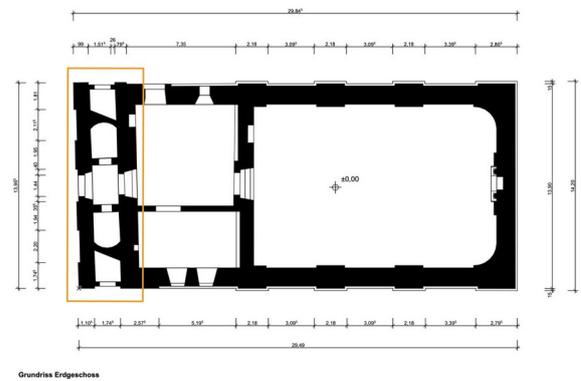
Grundriss Tonnengewölbe.jpg
